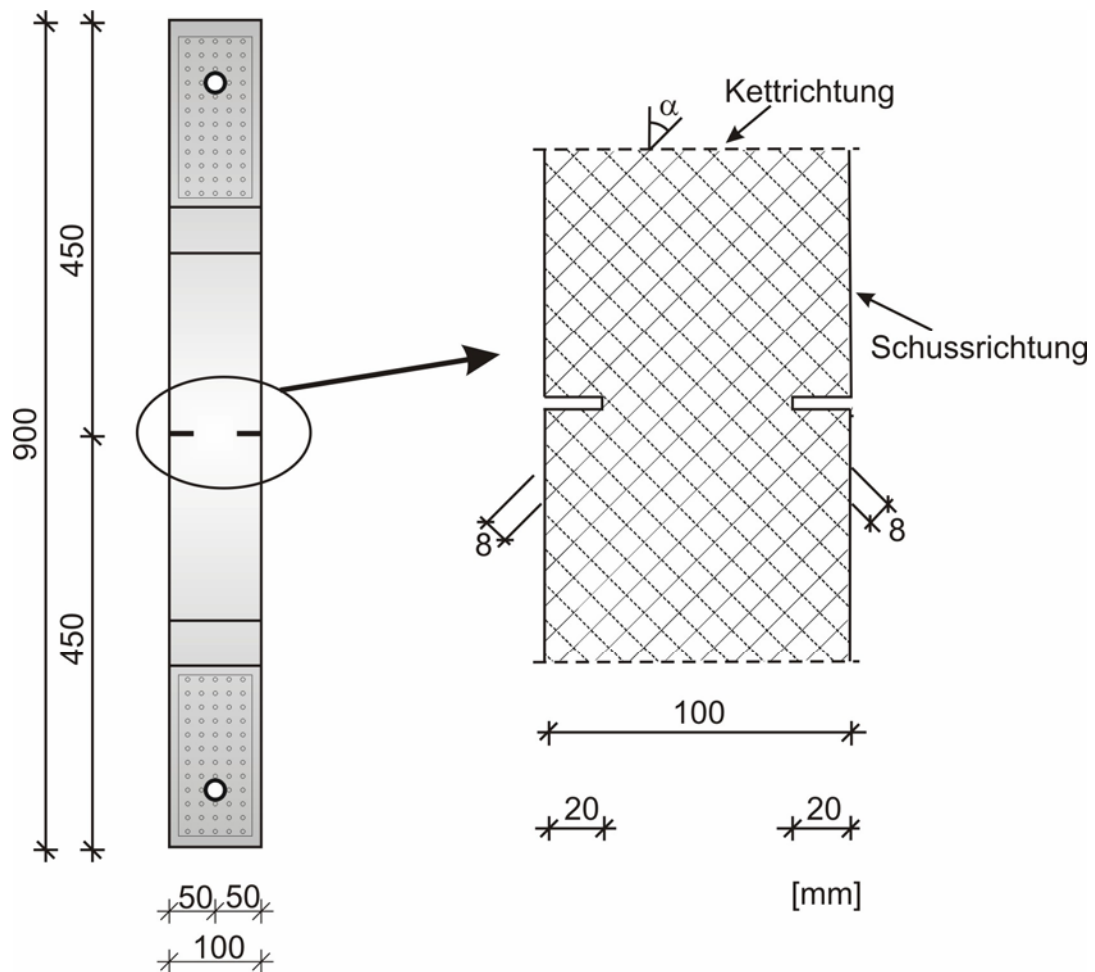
Versuchsaufbau der Dehnkörperversuche mit geneigter Bewehrungsführung
